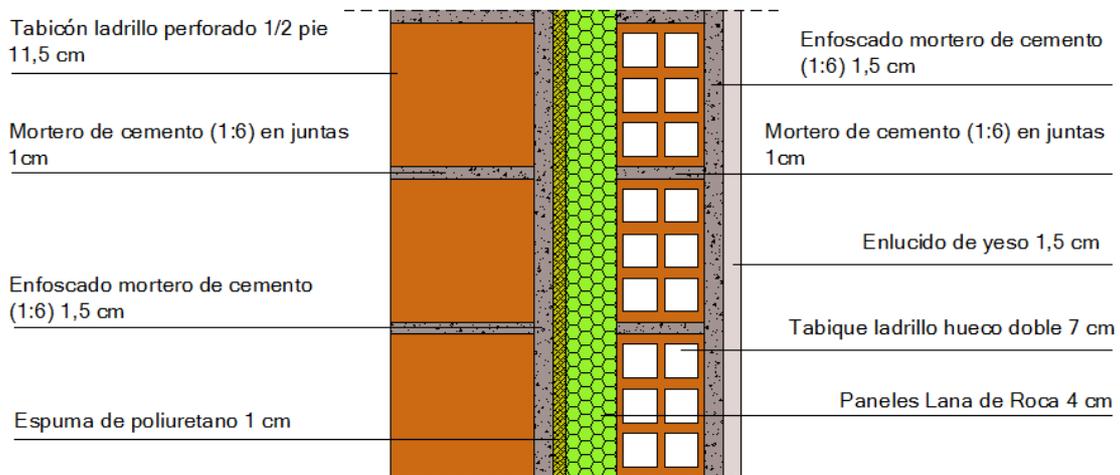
Detalle fachada tipo 1 zonas no húmedas.2014.CAD.
